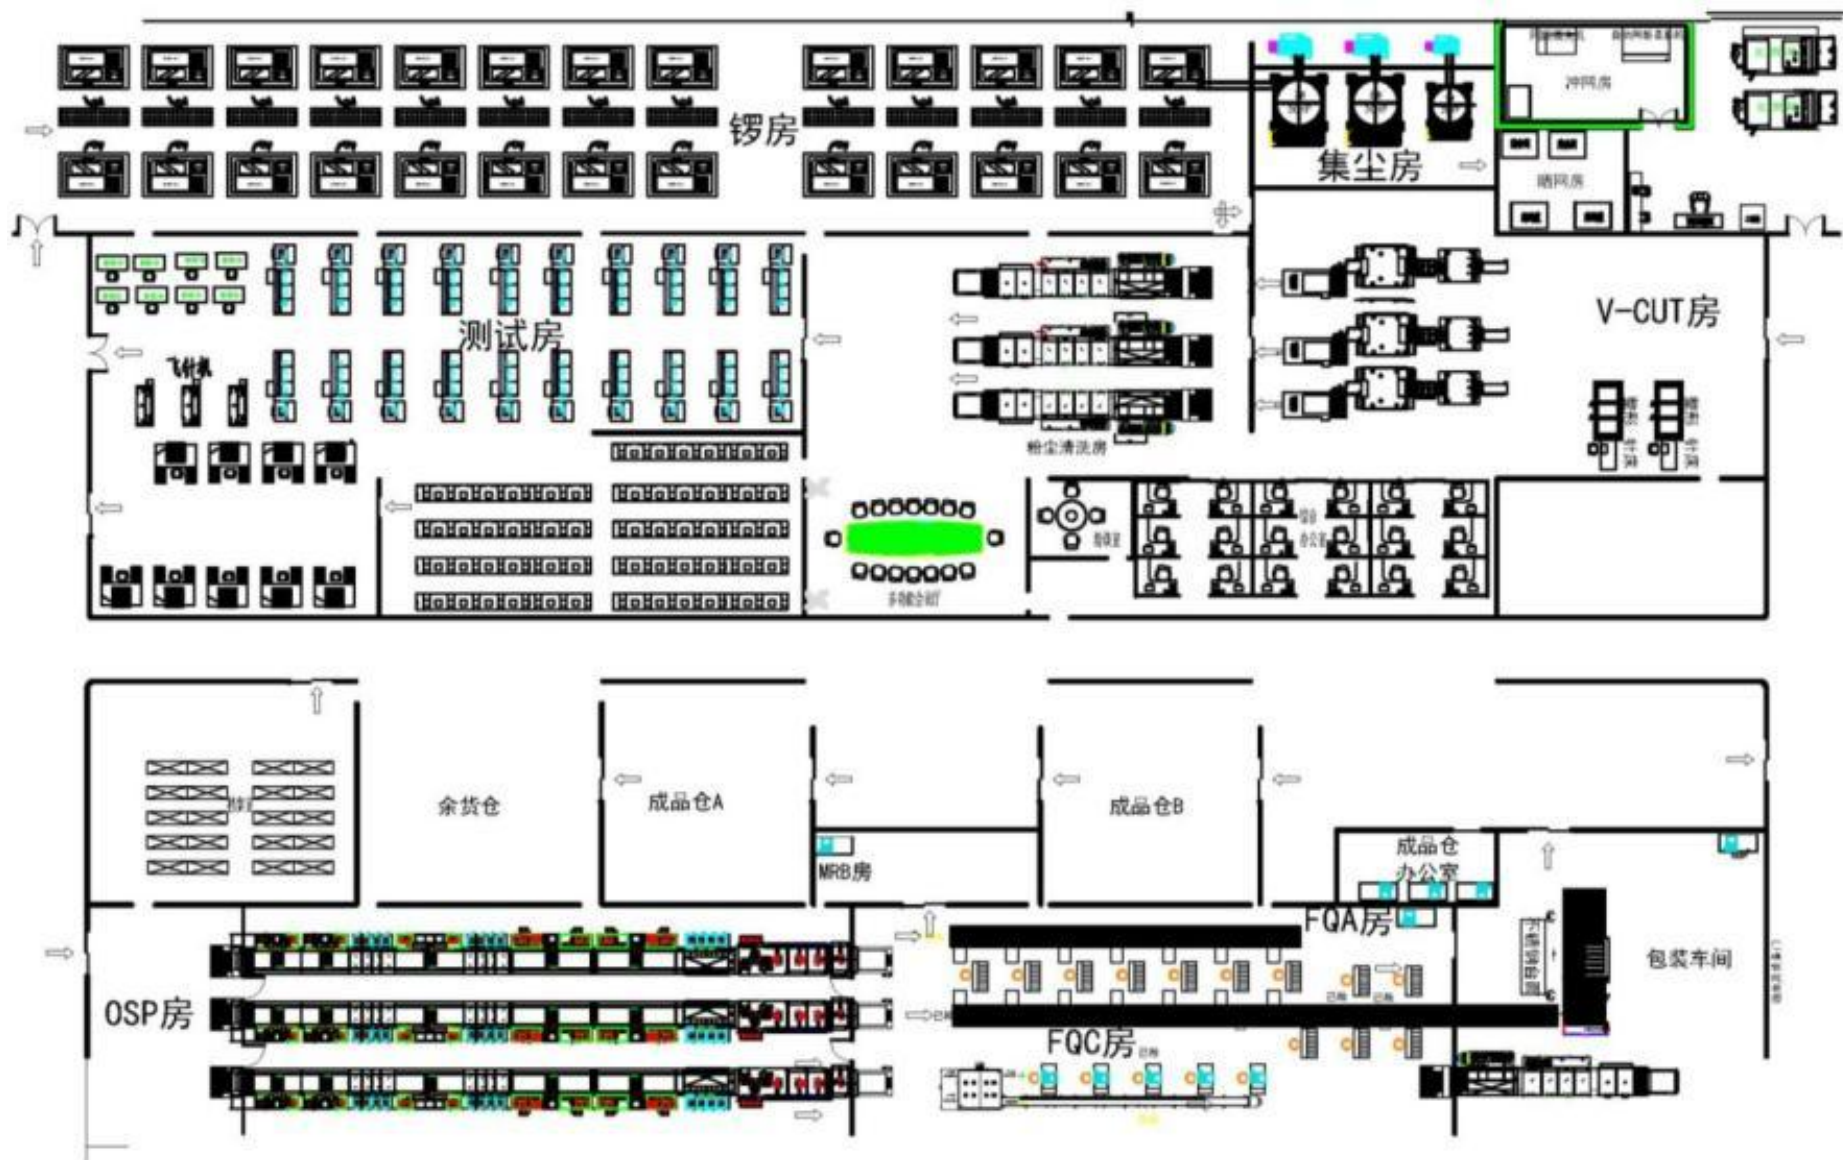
本项目二号厂房 5 楼环评阶段平面布置图
